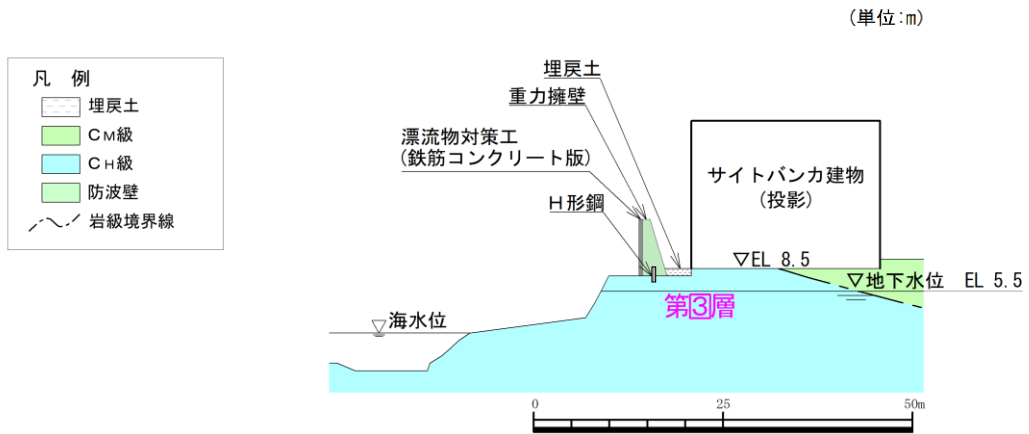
防波壁 (波返重力擁壁) の横断面図 (⑤-⑤断面)
